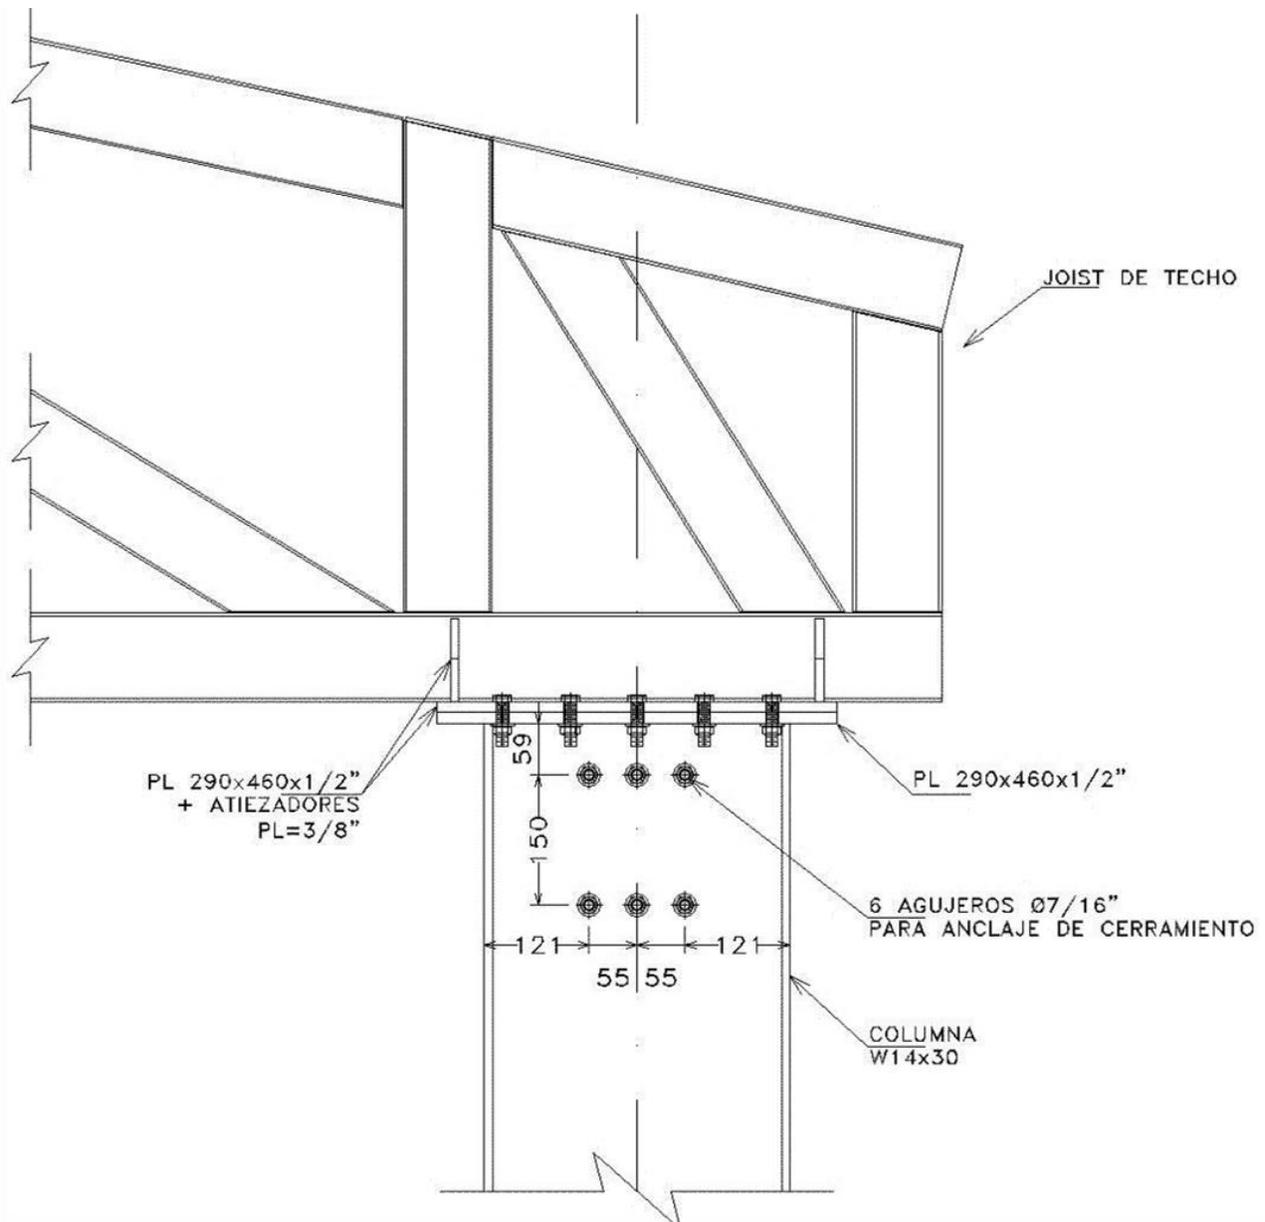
Detalle de anclaje de joist en columna por medio de pernos de doble roscado
